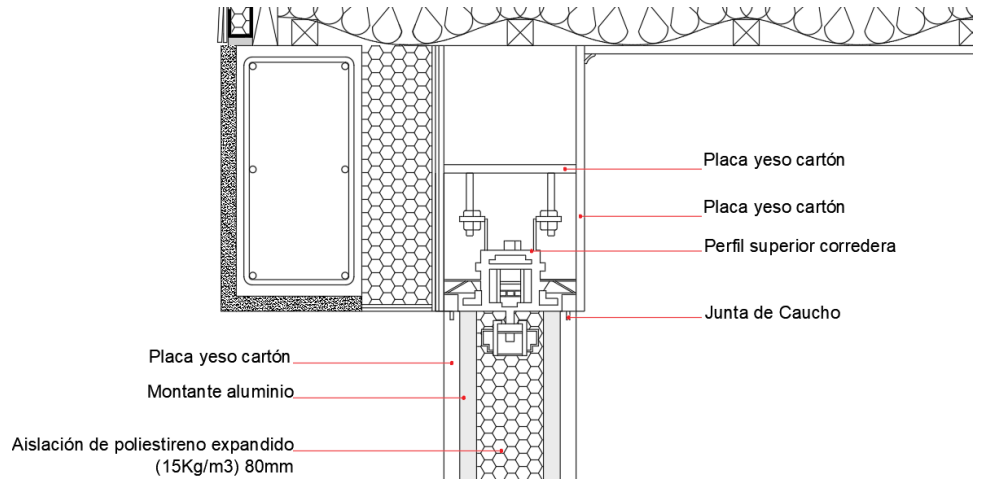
Escantillón muro corredera. Fuente: Elaboración Propia.
